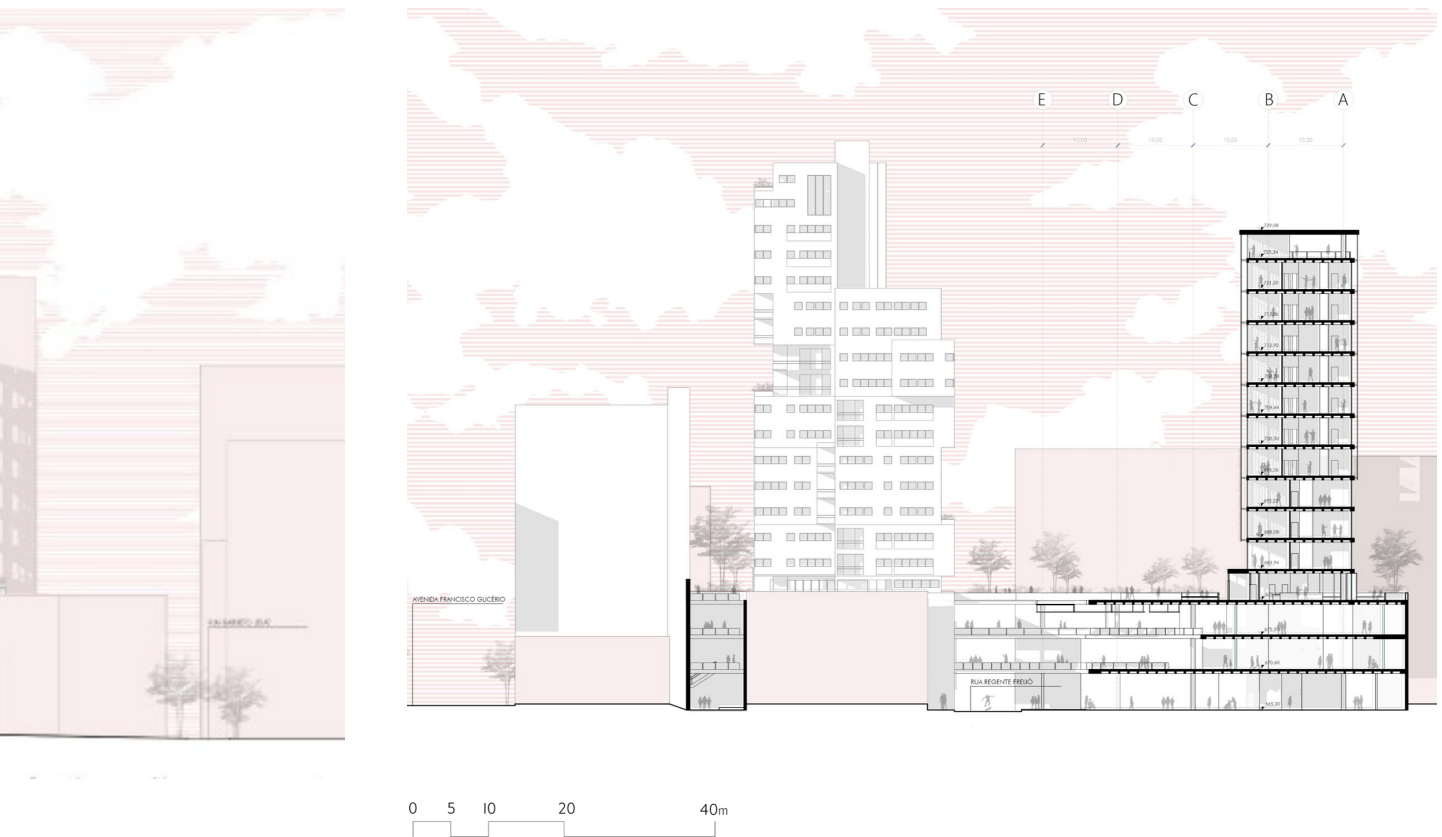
Corte DD / Fonte : Autoria do grupo.
